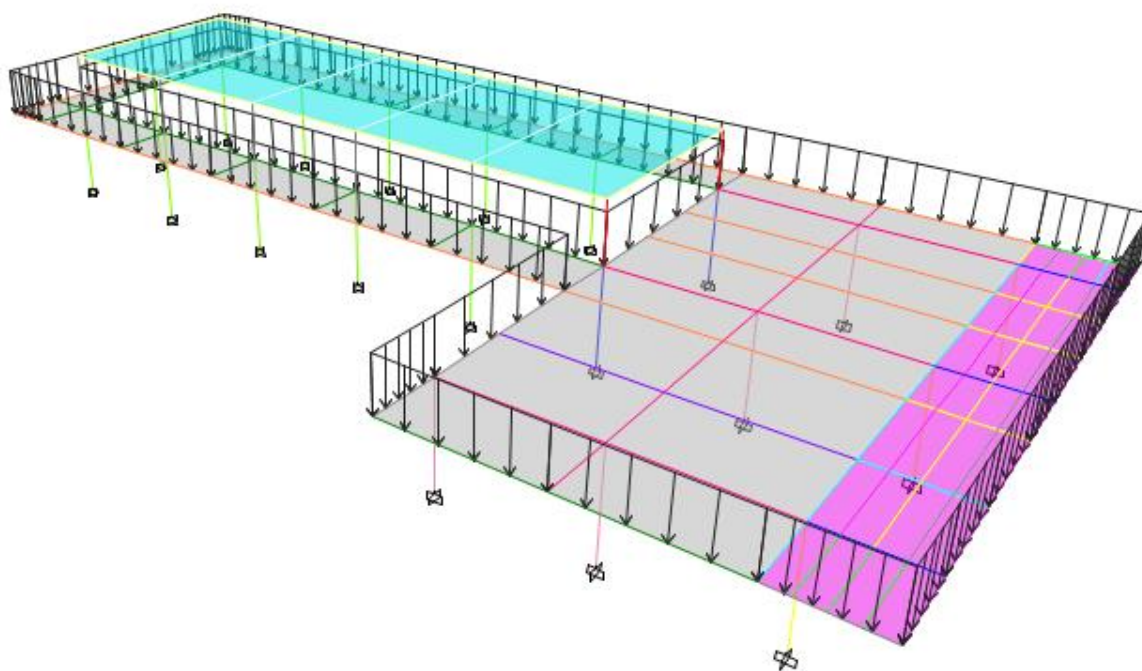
Cargas muertas sobre estructura de restaurante. Sobreimpuesta (KN/m)
